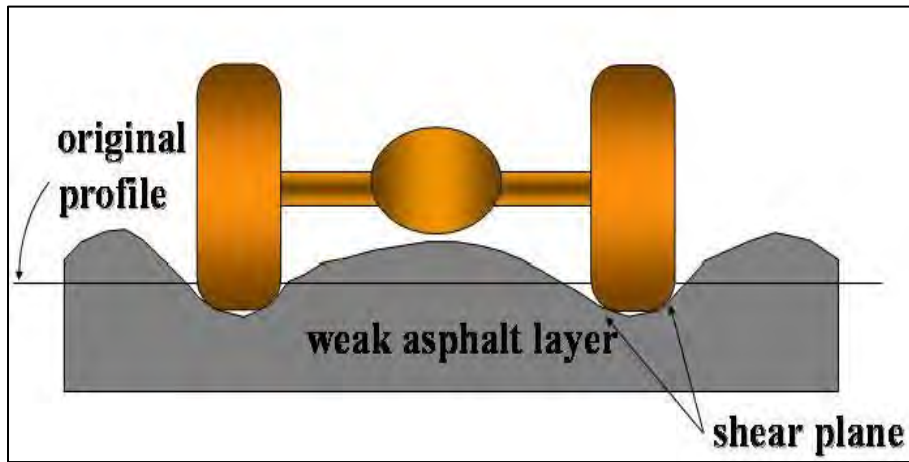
Falla por ahuellamiento debido a una mala implementación del pavimento.
